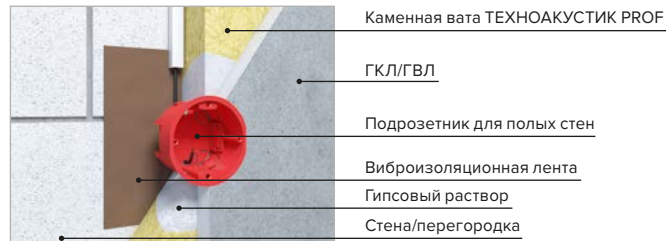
б. Вариант монтажа электропроводки в кабель-каналах и подрозетника с монтажом в гипсовую смесь
